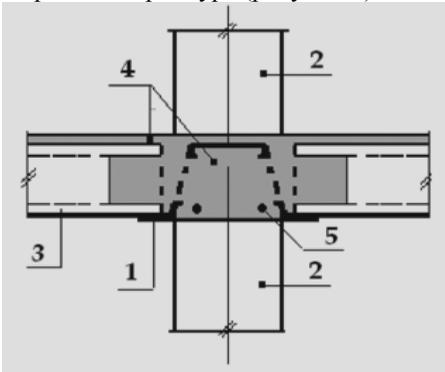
Стык колонны с плитным ригелем и плитами перекрытия
